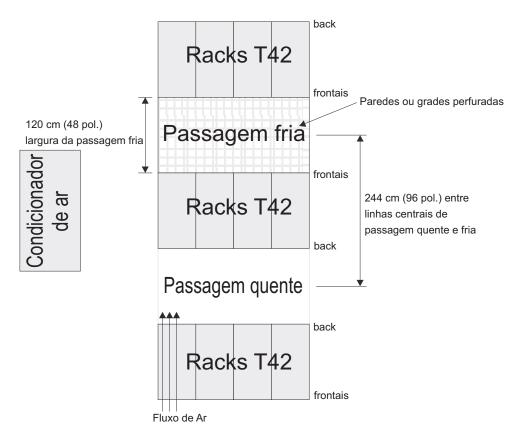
Exemplo de Configuração de Rack com Passagem Fria/Passagem Quente
